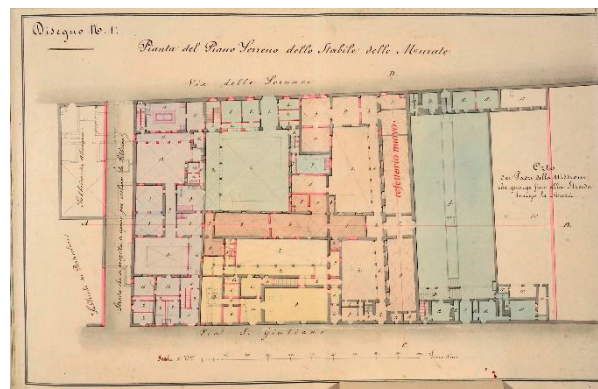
Pianta del piano terreno delle Murate durante le trasformazioni in carcere del 1837, con indicazione della localizzazione del refettorio nuovo dove era collocato il dipinto vasariano (foto Archivio di Stato di Firenze).
